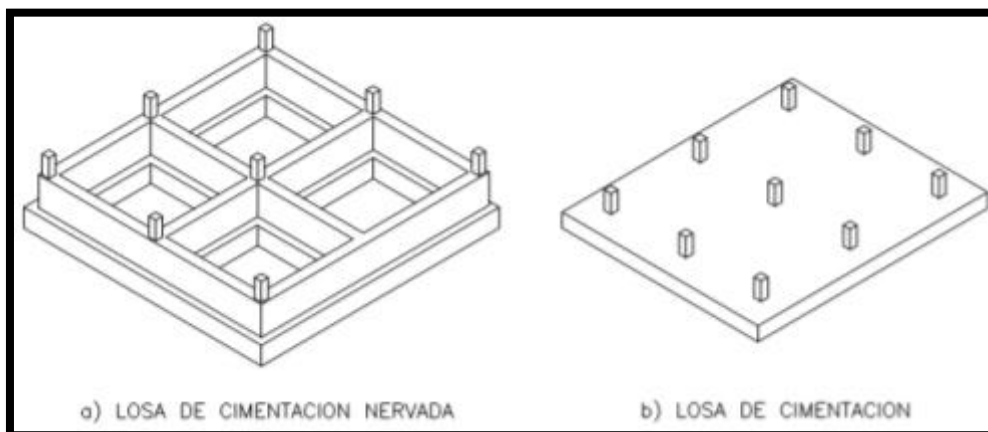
Tipos de Zapatas más utilizadas en el diseño y construcción.
